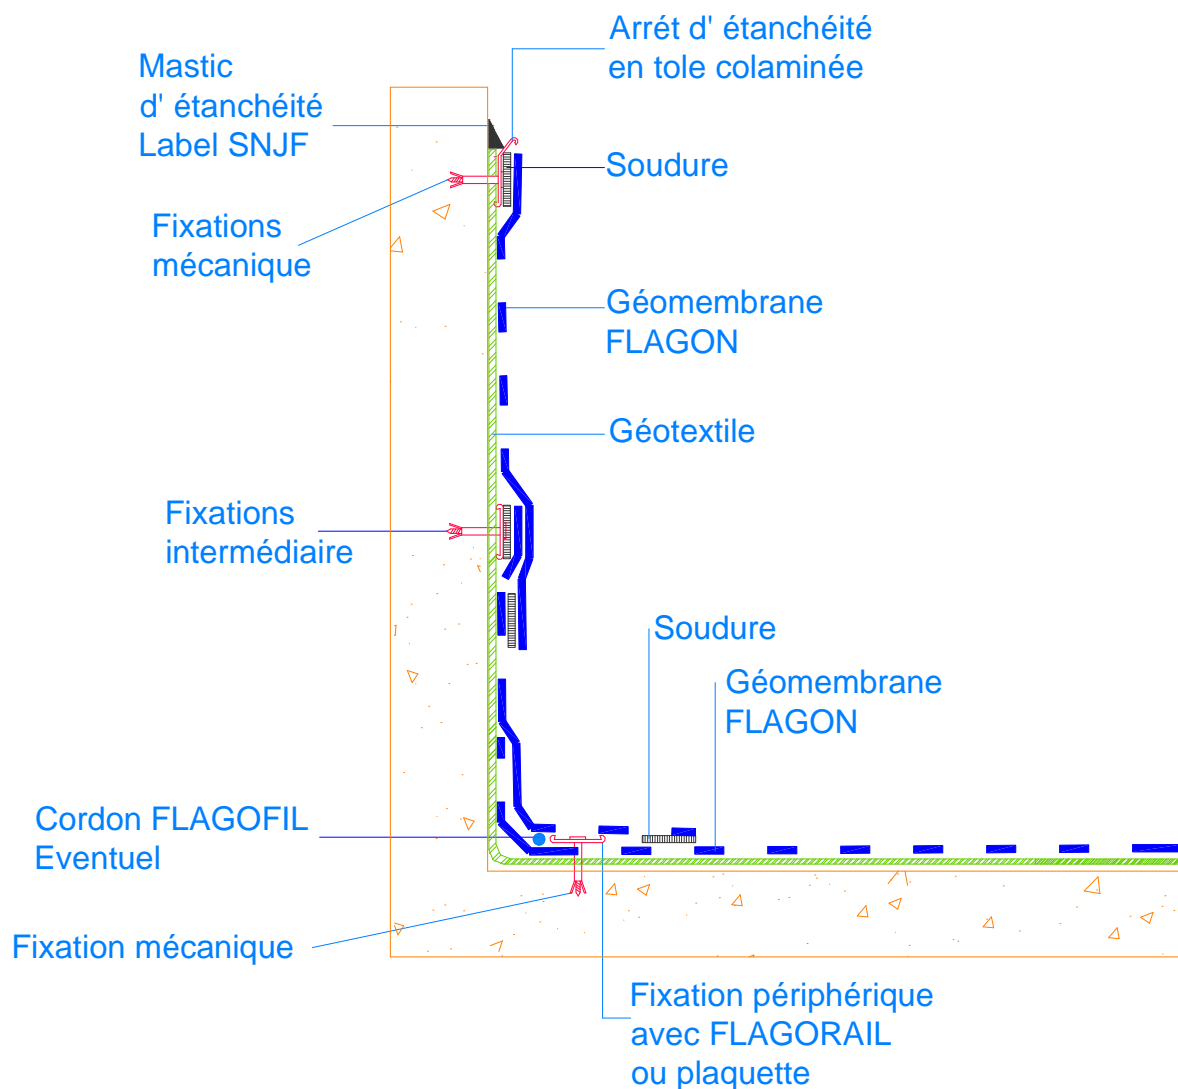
Fixation verticale sur ouvrage béton (coupe)
